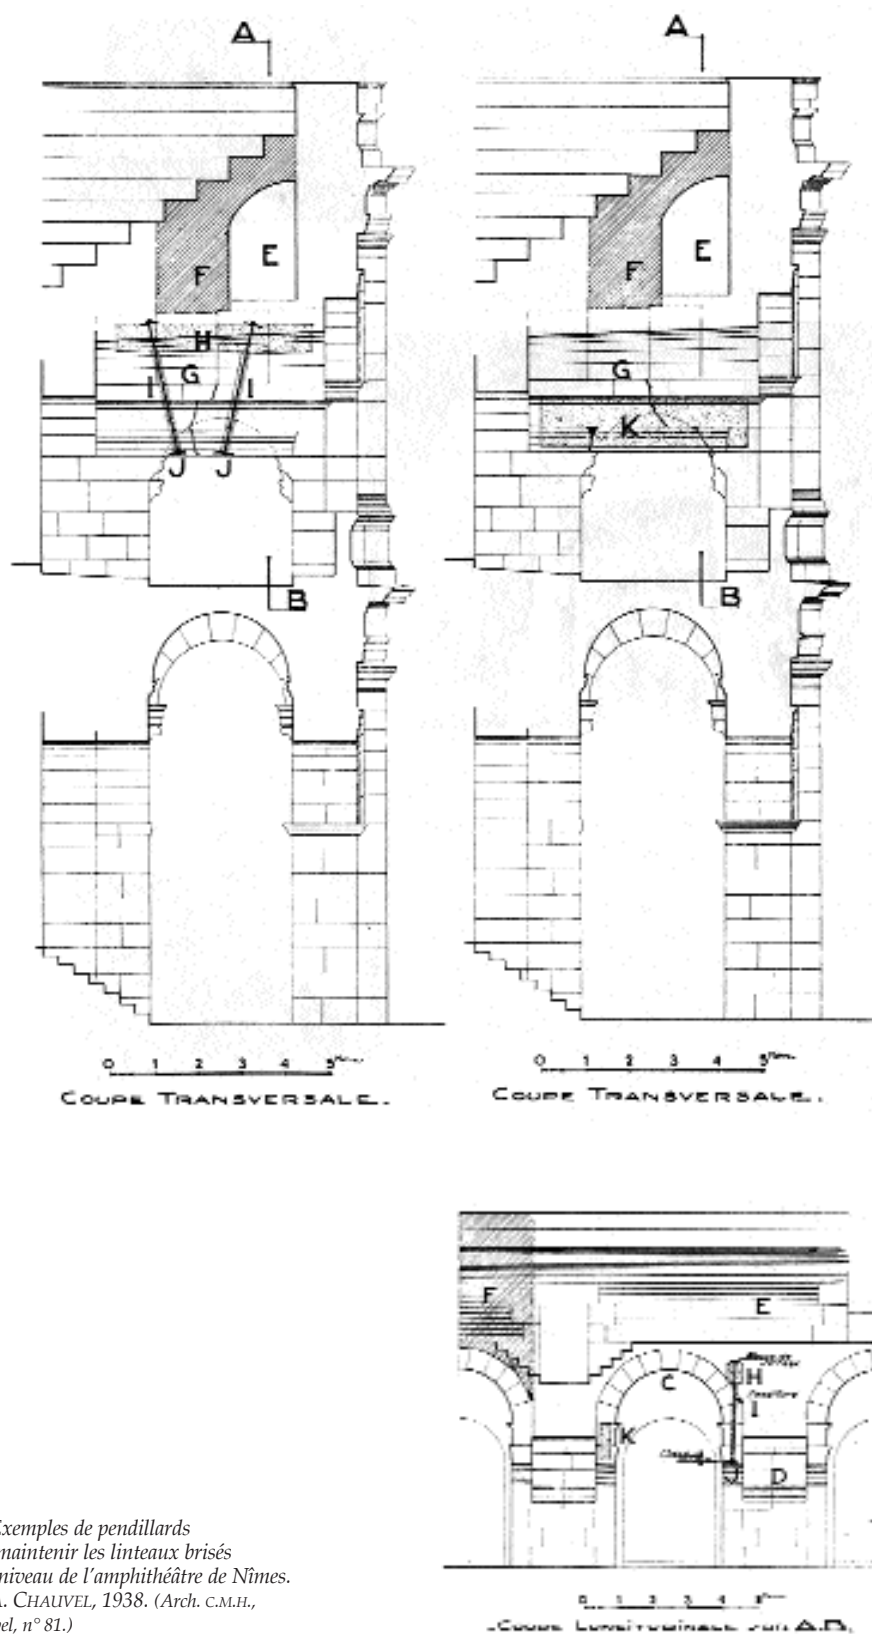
Exemples de pendillards destinés à maintenir les linteaux brisés du second niveau de l'amphithéâtre de Nîmes. Dessin d'A. CHAUVEL, 1938. (Arch. C.M.H., fonds Chauvel, n° 81.)
